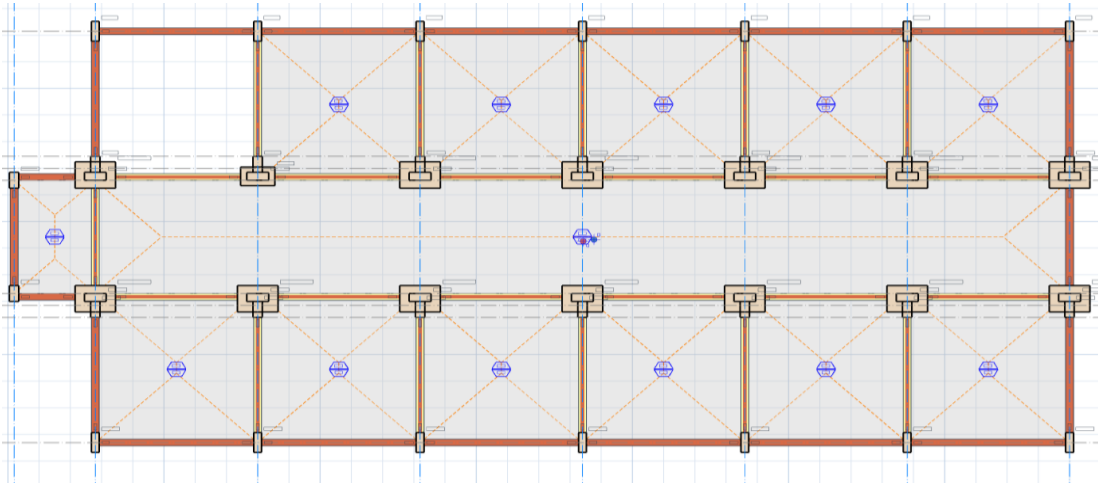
A blok 2. kısım 2. kat kat planı.
